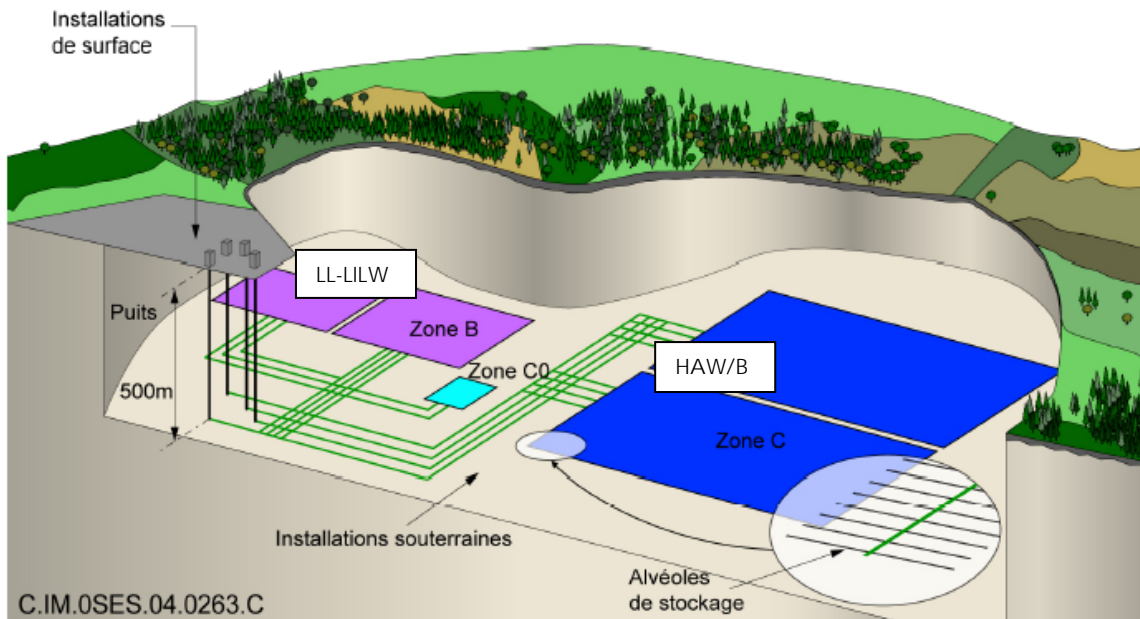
Schematisches Layout des geplanten Endlagers – Frankreich /2-25/
